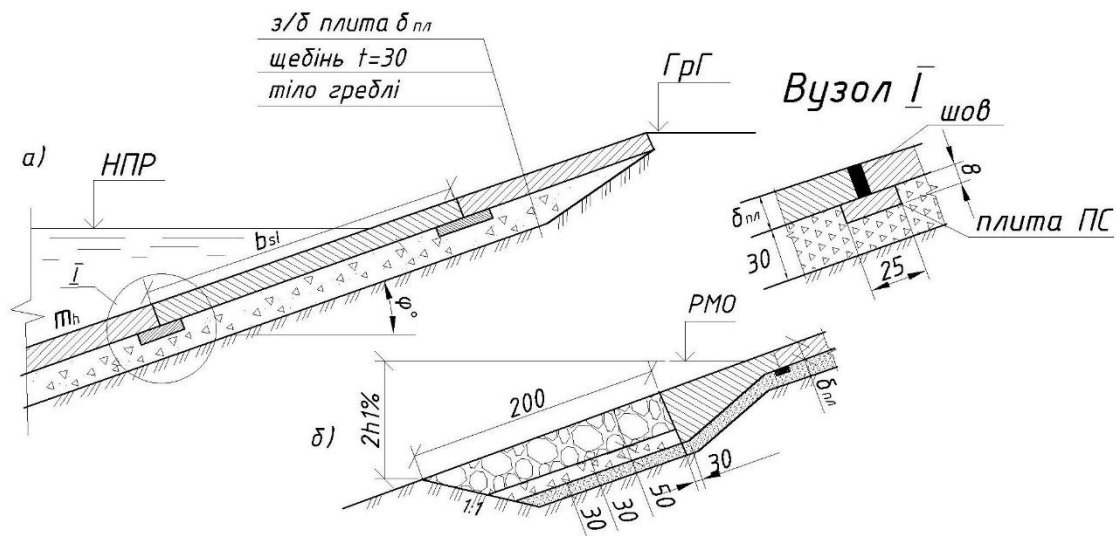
Бетонне кріплення верхового укосу: а) основне кріплення укосу; б) упор в кінці кріплення. Розміри вказано в см
